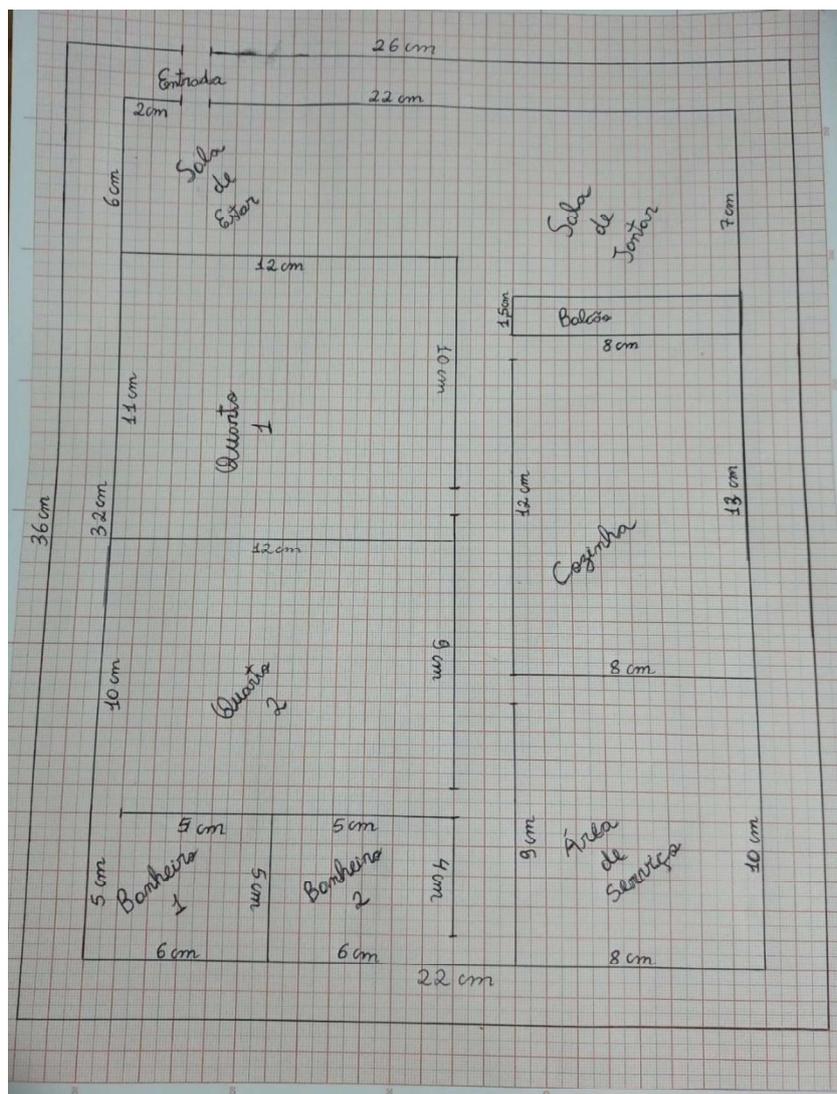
equipes desenvolvendo a planta baixa da maquete
